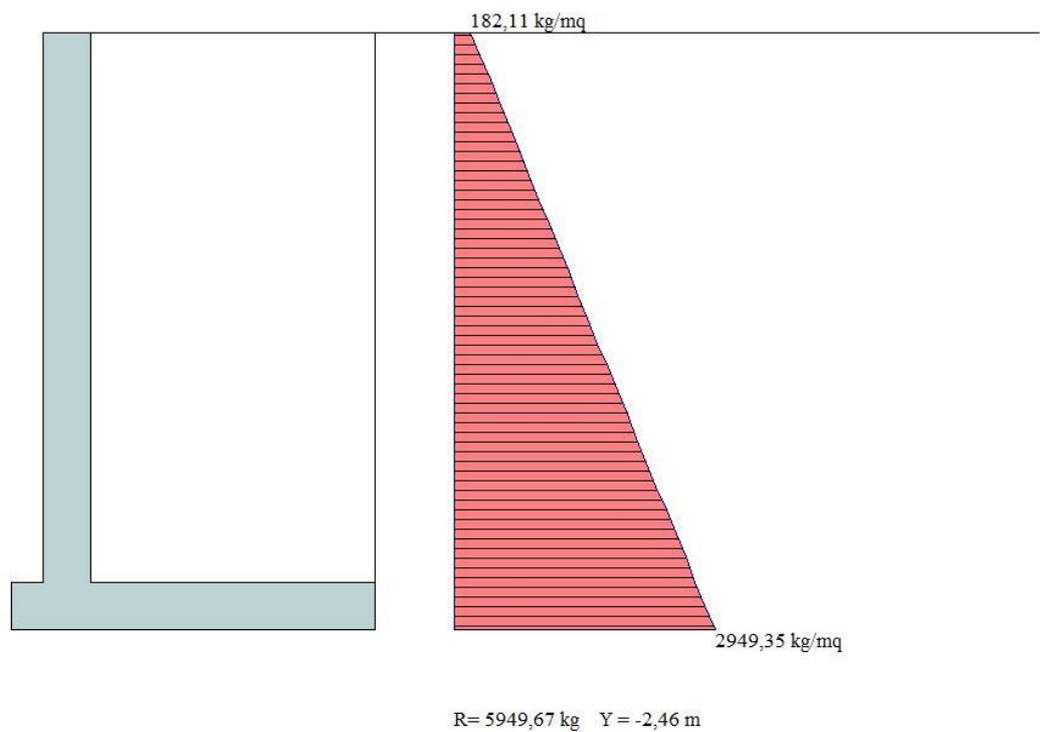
Sollecitazioni sulla struttura in elevazione in fase di esercizio
